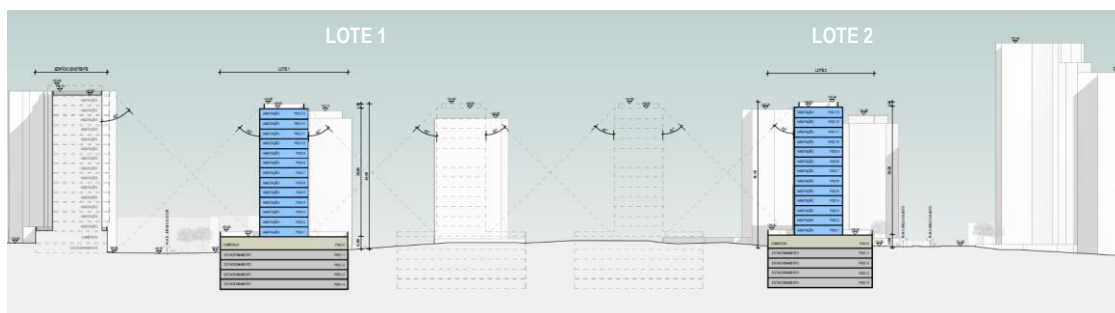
Perfil da proposta do Loteamento, lote 1 e lote 2.
